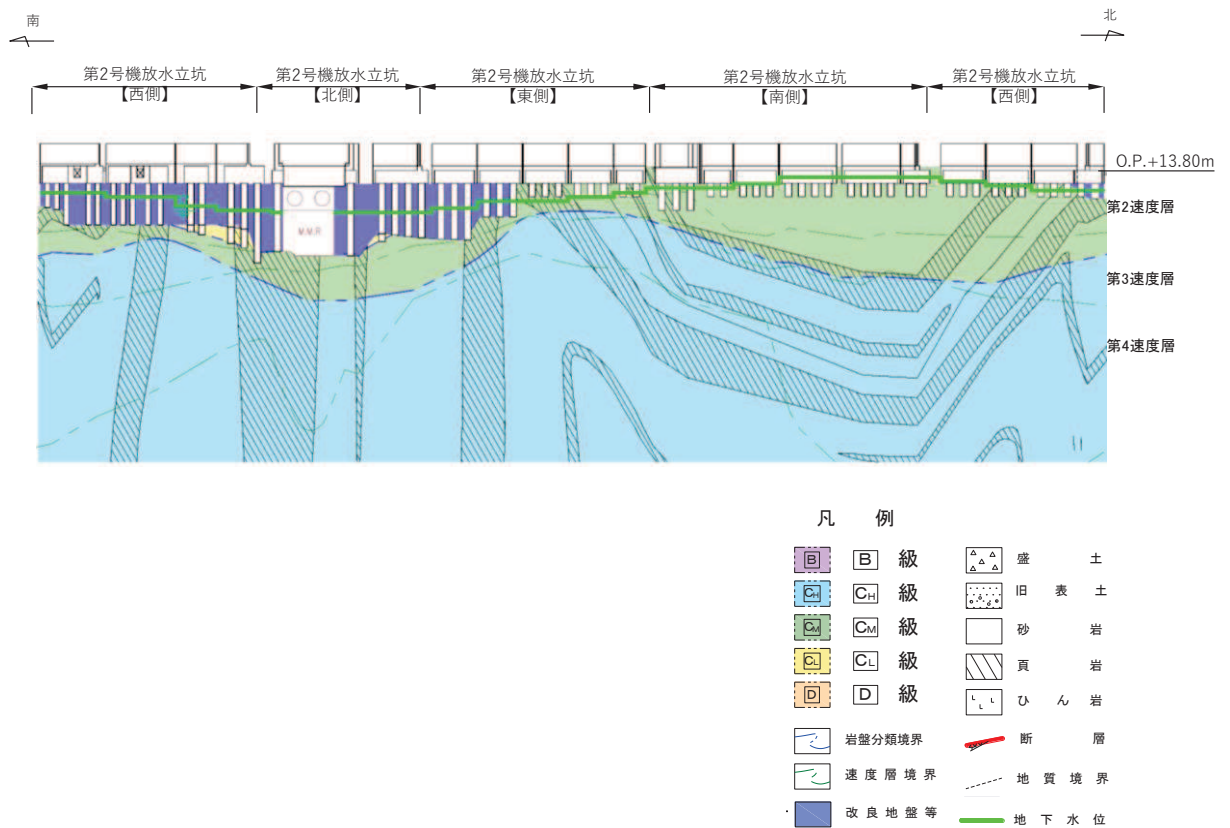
防潮壁（第2号機放水立坑）地質縦断面図
